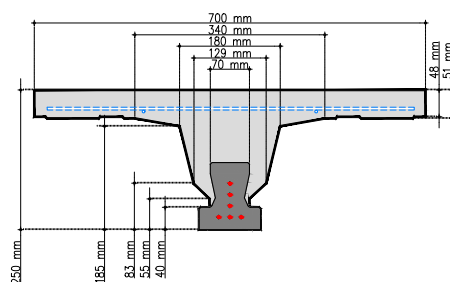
Control de fisuración, 30-T5-T12-CC5.
